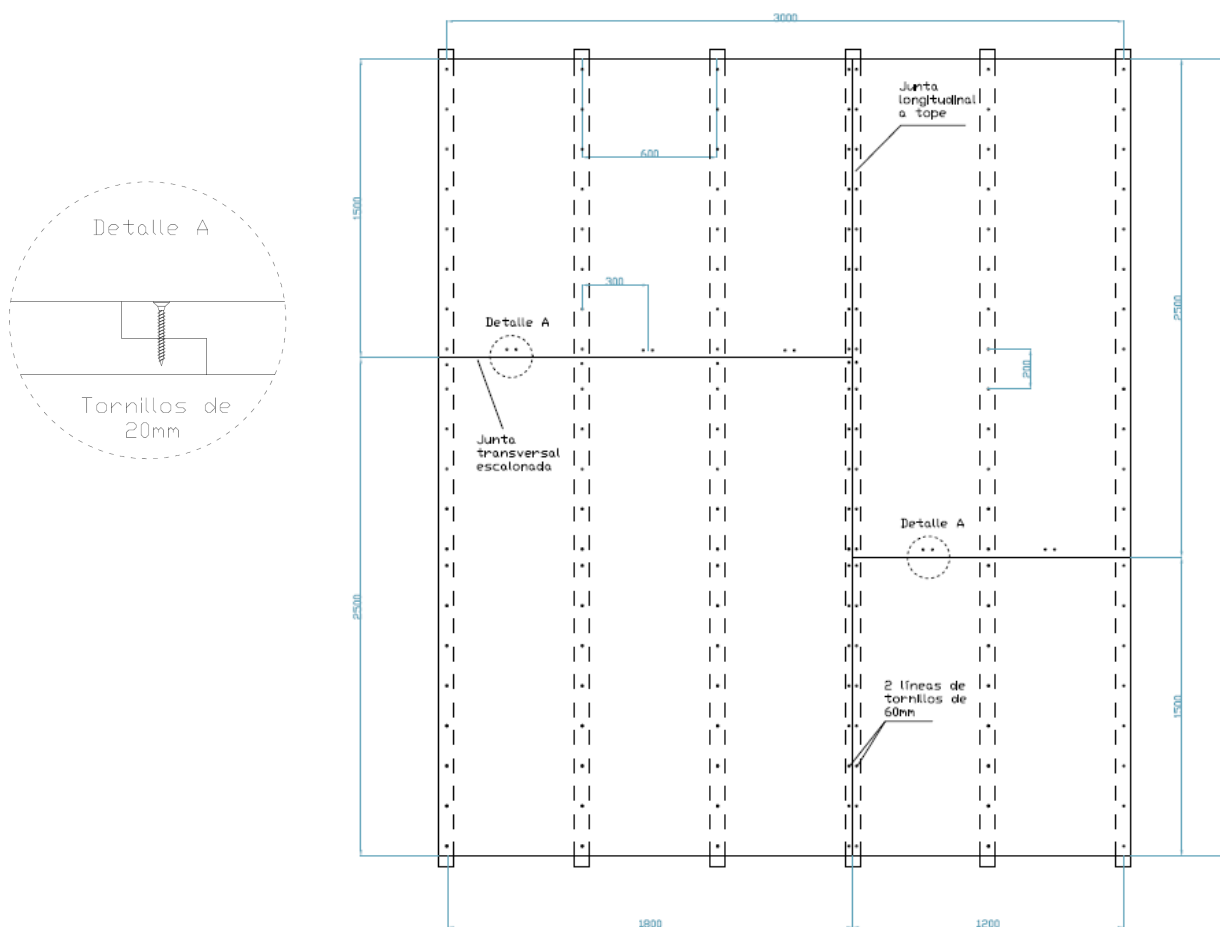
Distribución de las vigas de madera, juntas entre paneles y fijaciones mecánicas.
